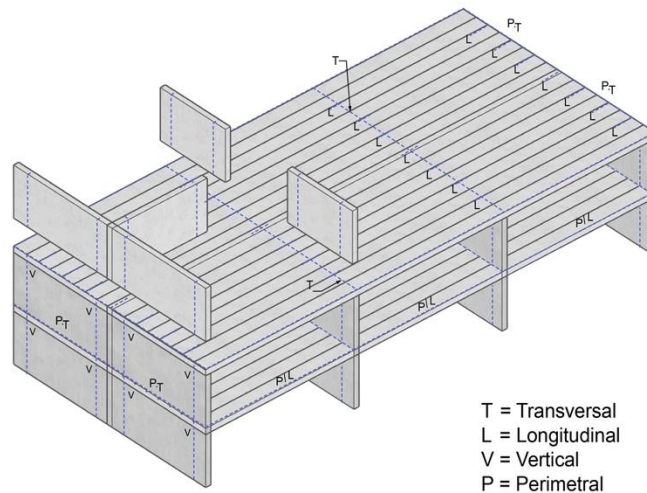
Arreglo de tensores de integridad en una estructura a base de losas y muros prefabricados (adaptada de ACI CODE-318-19)
